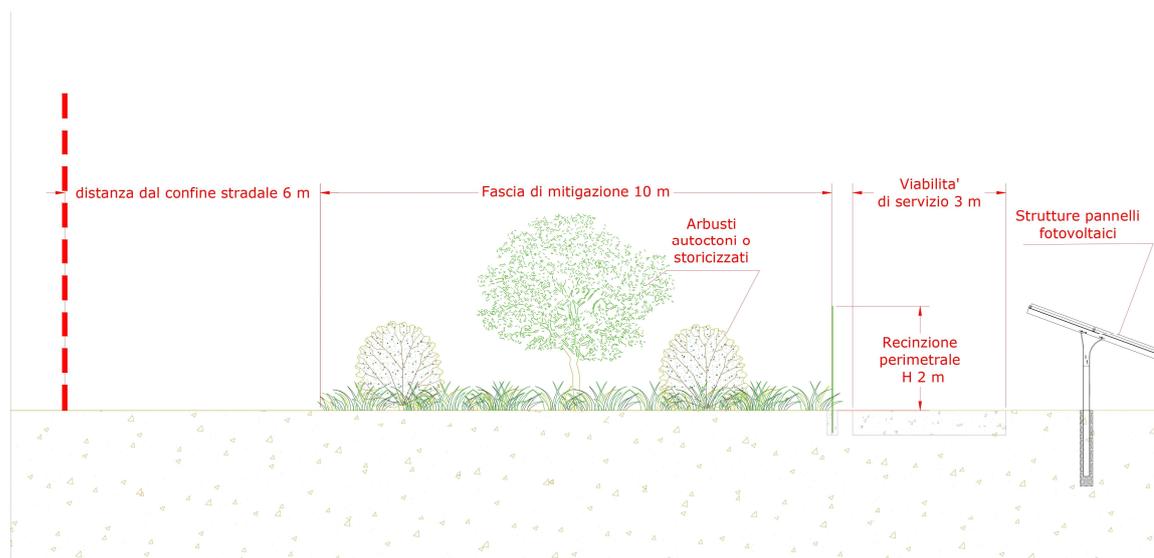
Particolare fascia di mitigazione lungo il perimetro dell'impianto – particolare lato nord
